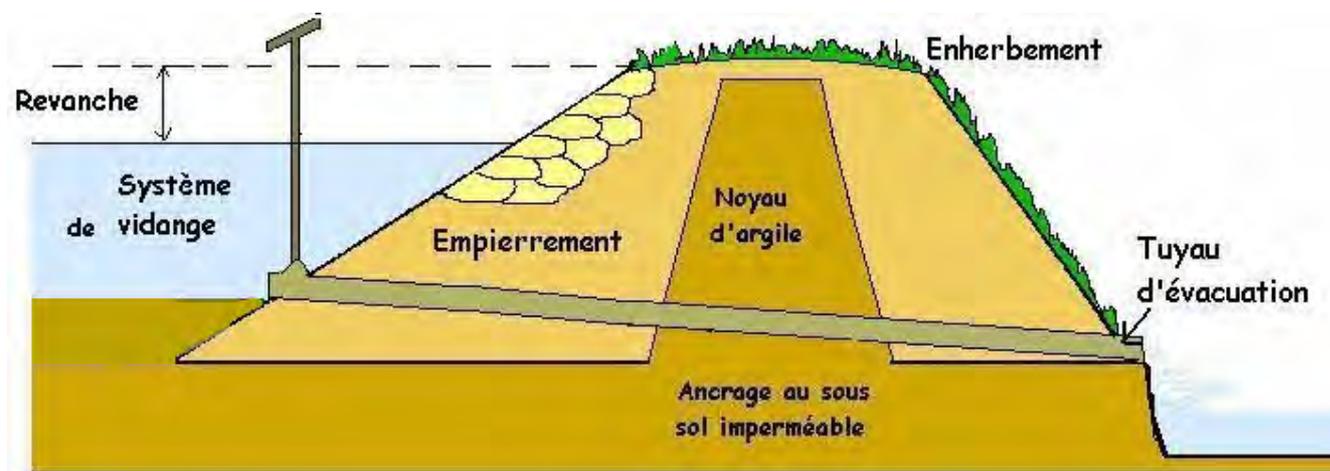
Chaussée ou digue vue de profil (d'après Breton, 2001)
